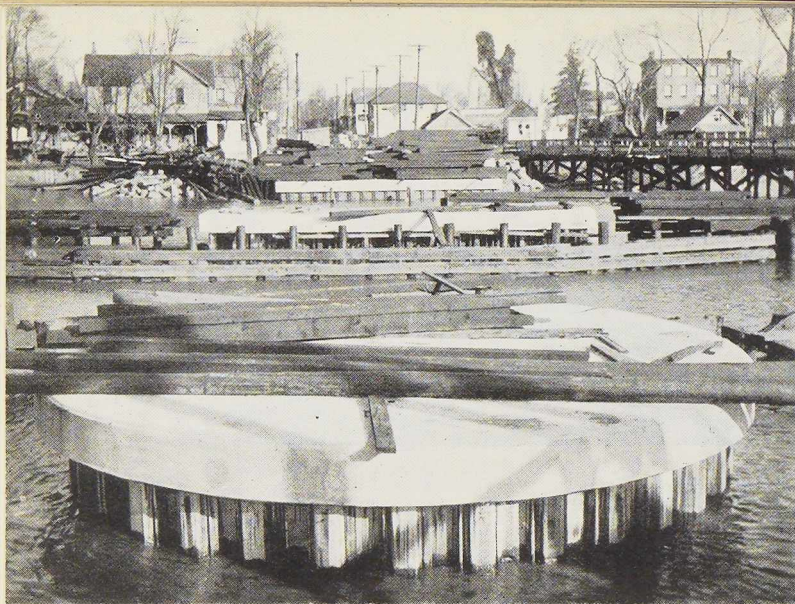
Pile centrale fondée sur palplanches métalliques. A l'arrière-plan la pile de rive et la culée sont également fondées sur palplanches métalliques.
